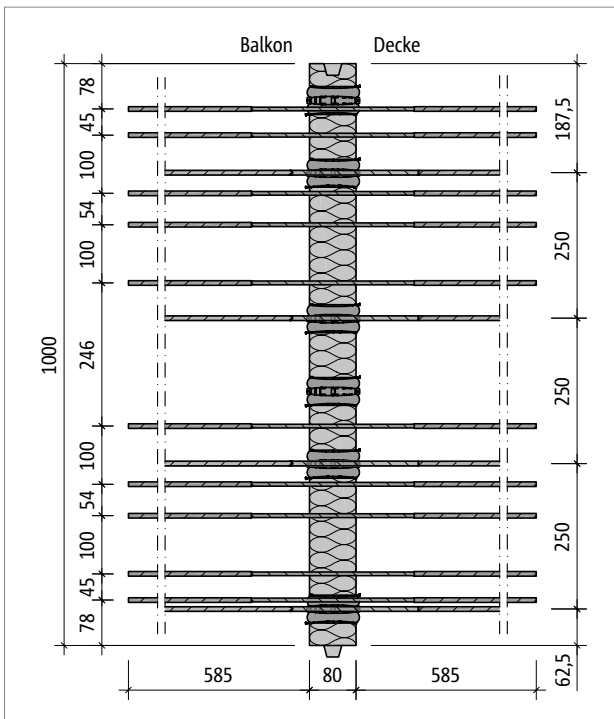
Schöck Isokorb® T Typ KL-M4-V1: Produktgrundriss
